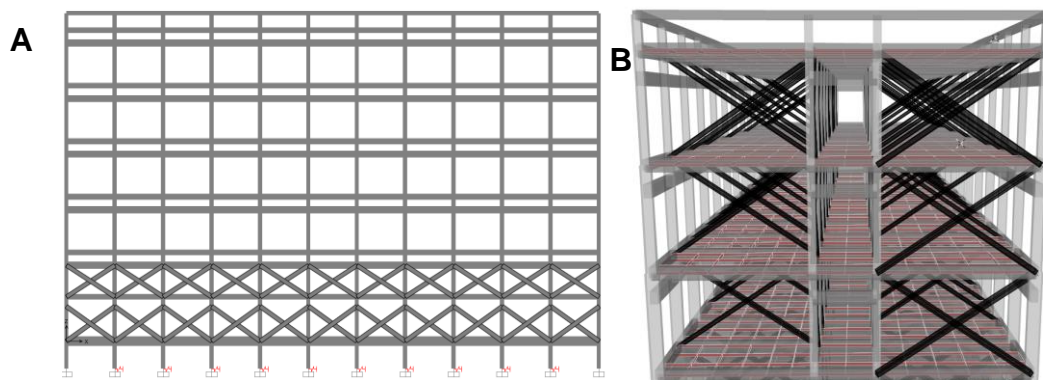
Paredes de Alvenaria modeladas no edifício em estudo: (A) vista do plano x-z ; (B) vista 3D segundo o plano y-z [6]
